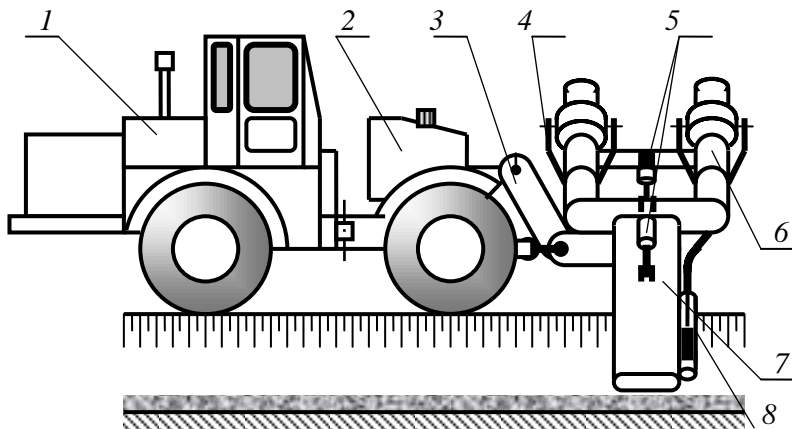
Схема газодинамического (газоструйного) каналаочистителя.
